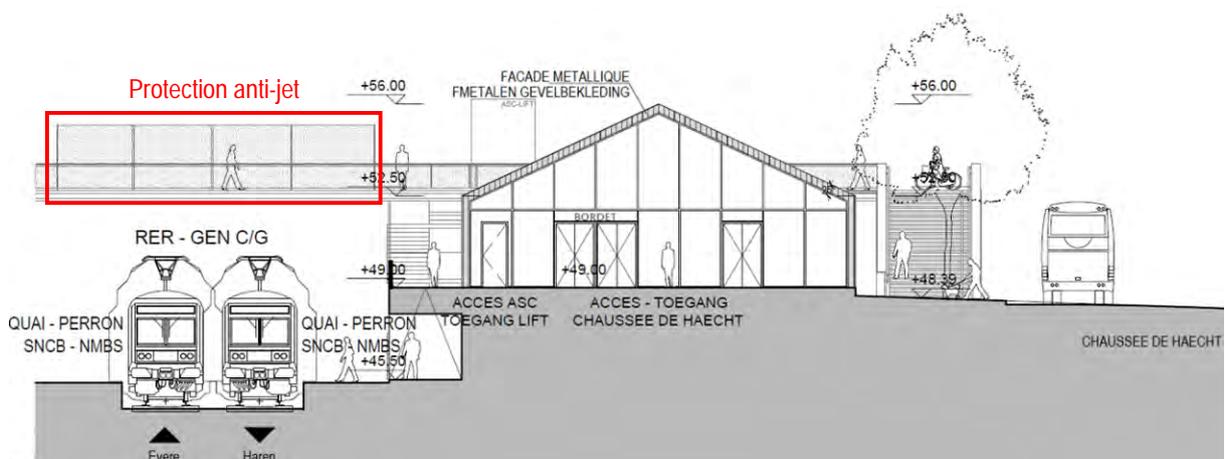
Coupe transversale du pavillon « Petit Bordet » et vue sur la passerelle (BMN, 2018)
